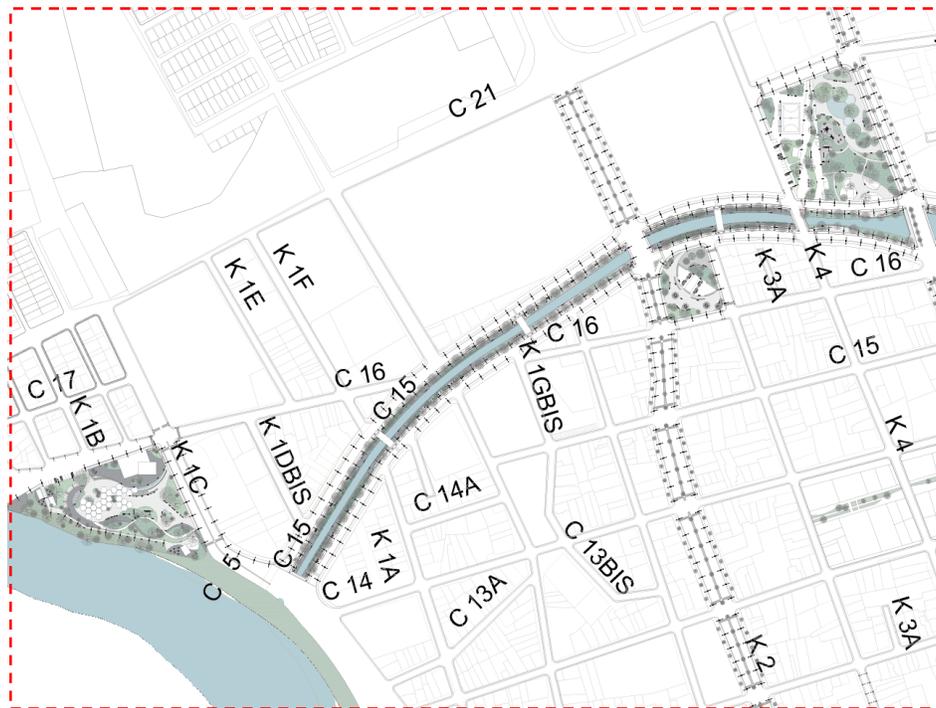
Plano General – Propuesta Urbana Sección 1
